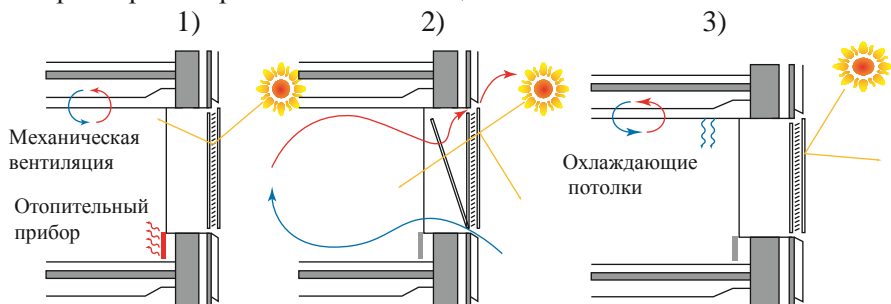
Схема климатизации помещения в здании Commerzbank в разные периоды года: 1 – зимний период (наружная температура – 5...10°C) – окна закрыты, используются отопление и механическая вентиляция; 2 – летний период (наружная температура 10–24 °C) – окна открыты, используется естественная вентиляция; 3 – летний период (наружная температура 24–32 °C) – окна закрыты, используются механическая вентиляция и охлаждение посредством охлаждающих потолков
